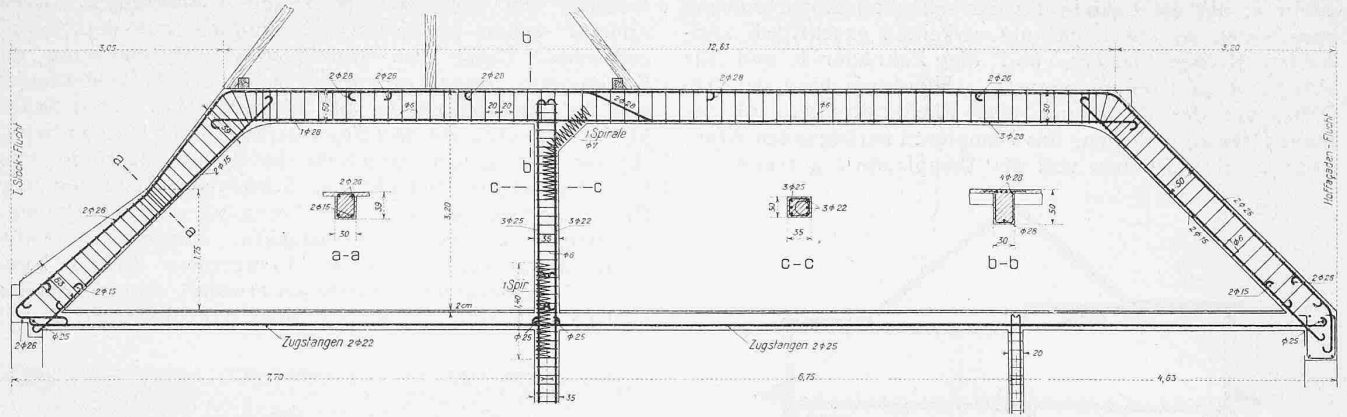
Armierungsplan des Dachbinders G. — Masstab 1 : 100.
